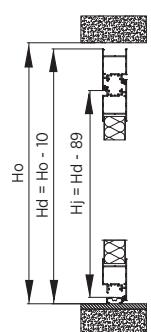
Montaggio in foro - sezione verticale - porta a un'anta - sistema AW45.
